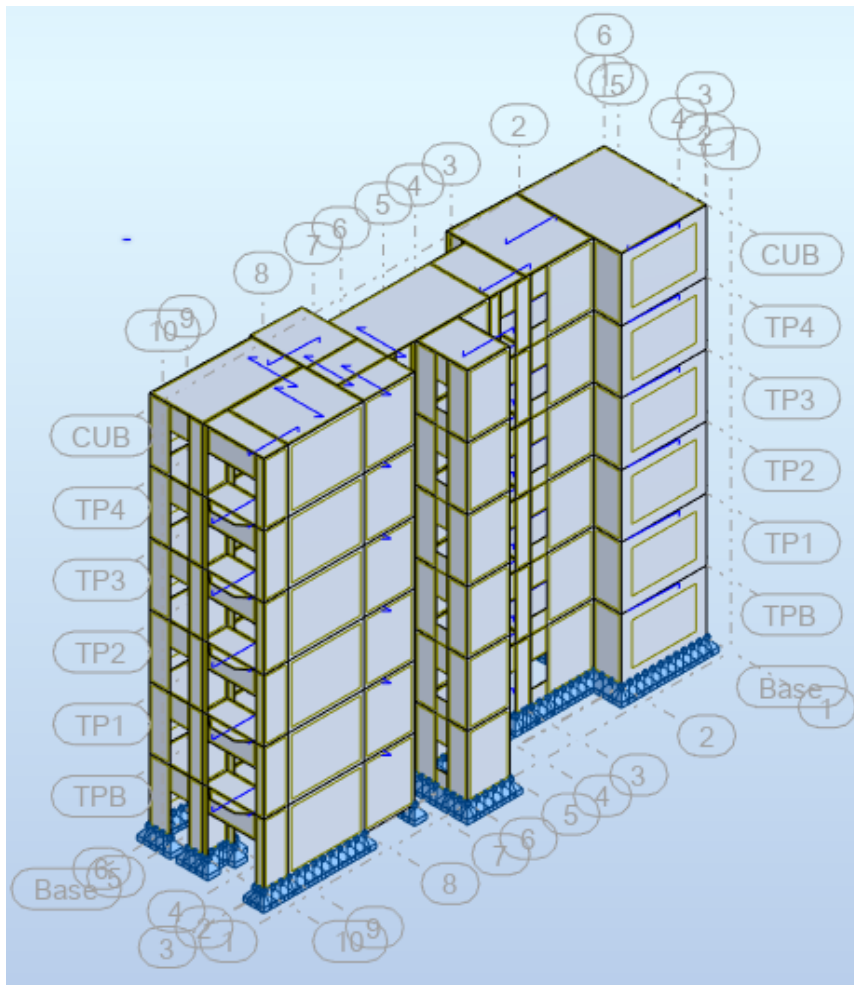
Vista 3D general de la estructura. Fuente: elaboración propia
